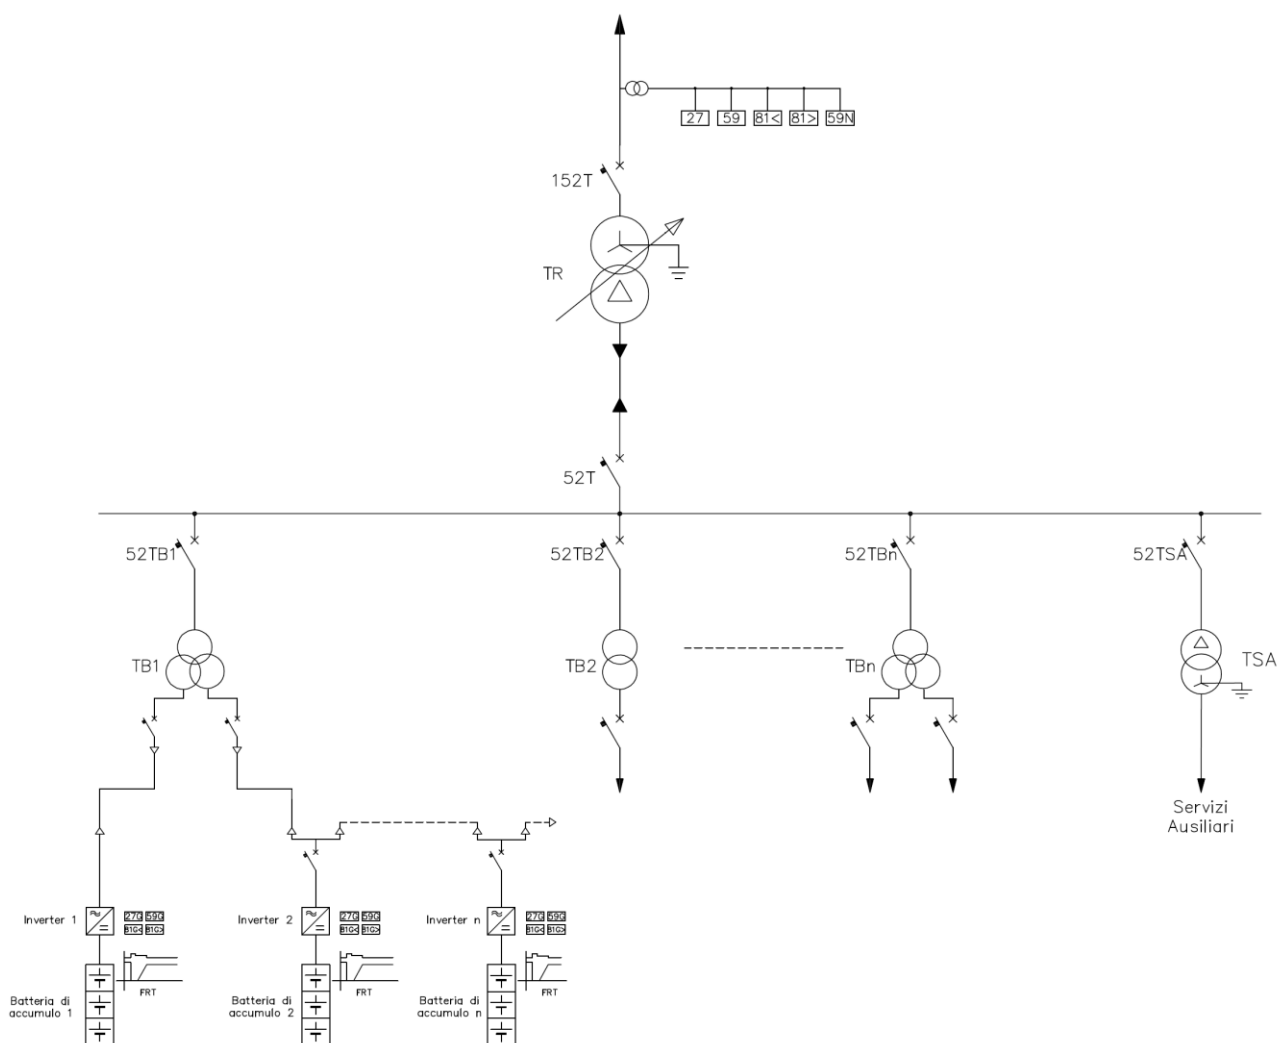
Assetto delle protezioni contro i guasti e le perturbazioni nella rete di connessione AT di un Impianto di Accumulo
